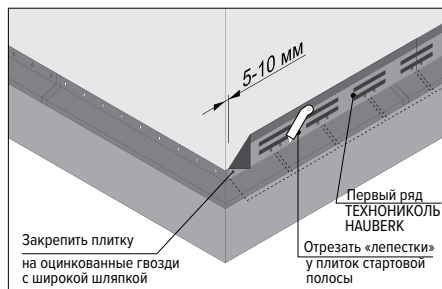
Монтаж стартовой полосы фасадной плитки
